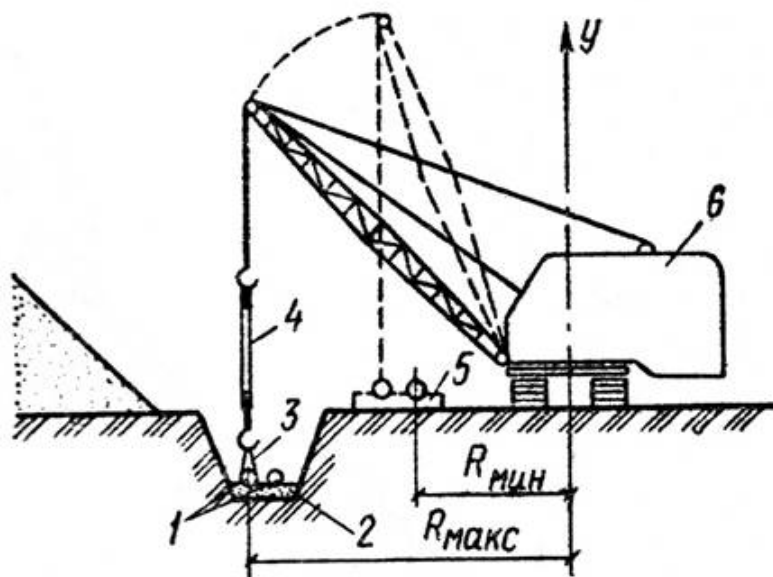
Укладка стальных труб с тепловой изоляцией:
